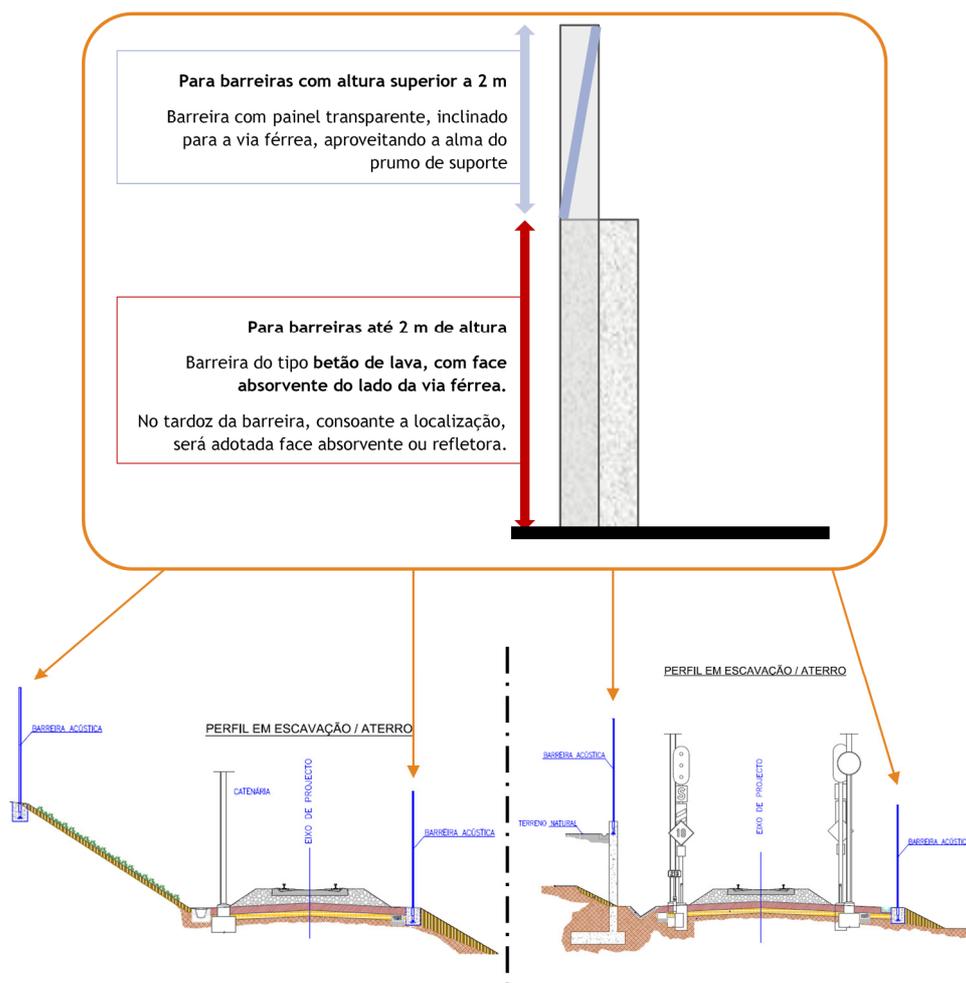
Esquema com o pormenor da alteração da combinação de materiais constituintes das barreiras acústica (BA), sem alteração do desenvolvimento em planta da BA, uma vez que se aproveita a largura da alma do perfil estrutural para inclinação do painel transparente em direção à via-férrea.
